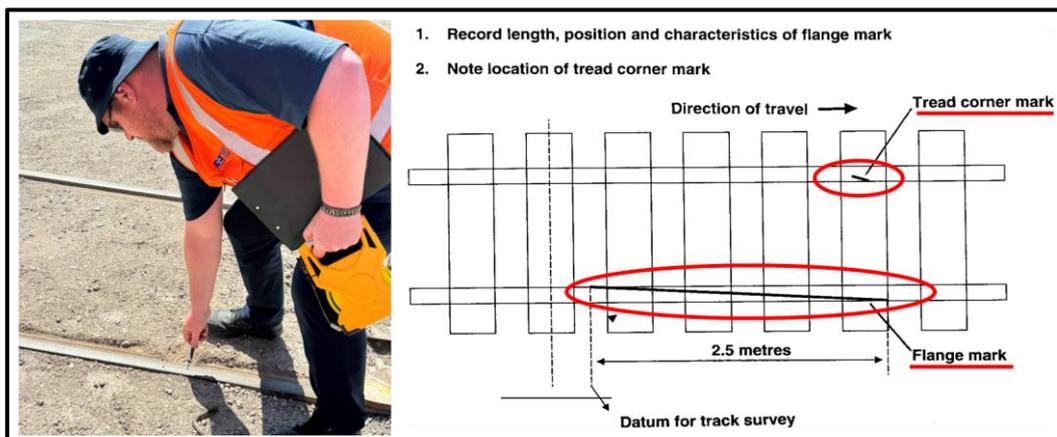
講師標示 Tread corner mark 及 Flange mark
